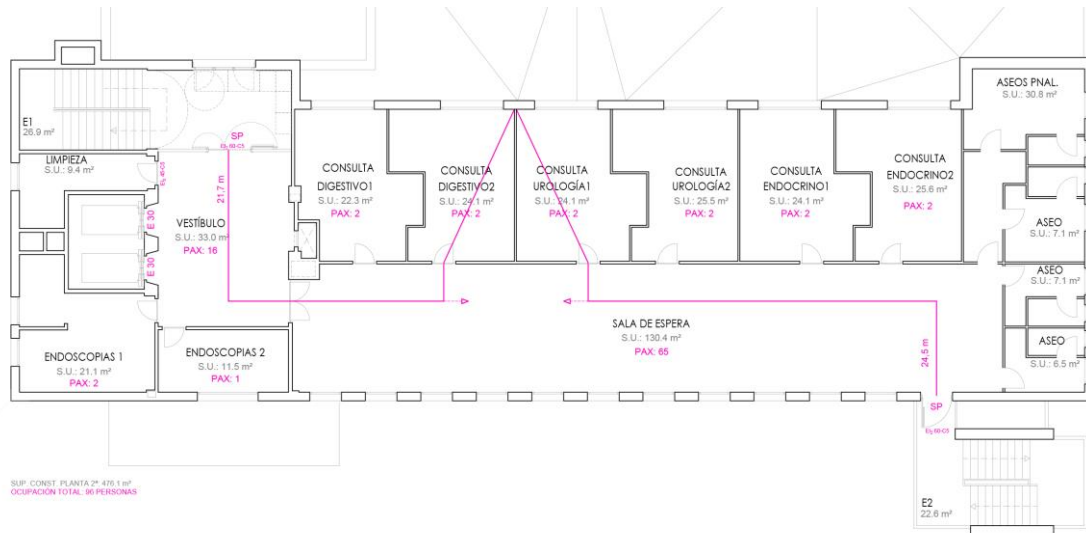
Planta de sectorización de la planta segunda. (Planta tipo)
